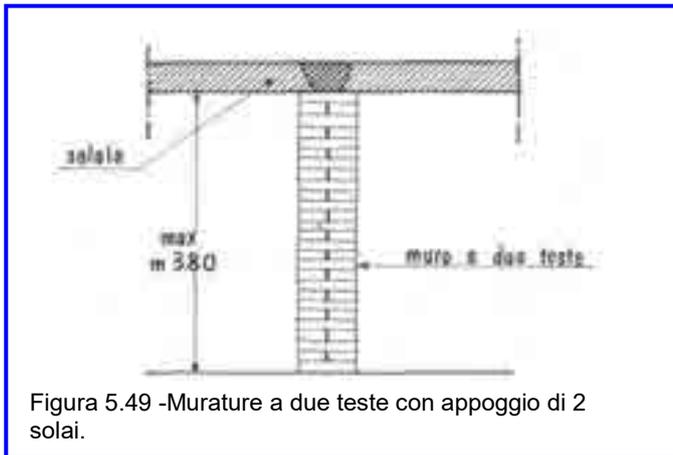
Murature a due teste con appoggio di 2 solai.
